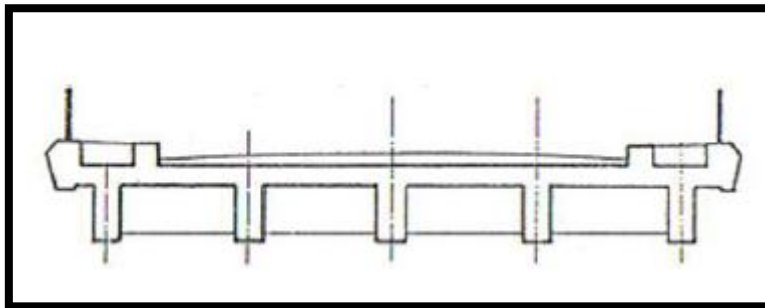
Passage supérieur ou inférieur à poutres armées (PSIPA).
